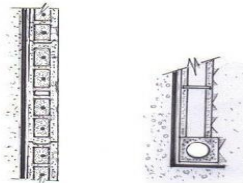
Detalle de Muro en voladizo de mampostería con sistema de drenaje. (Modificado de [http://www.construmatica.com/construpedia/Construcci%C3%B3n\\_de\\_un\\_Muro\\_de\\_Contenci%C3%B3n](http://www.construmatica.com/construpedia/Construcci%C3%B3n_de_un_Muro_de_Contenci%C3%B3n))
